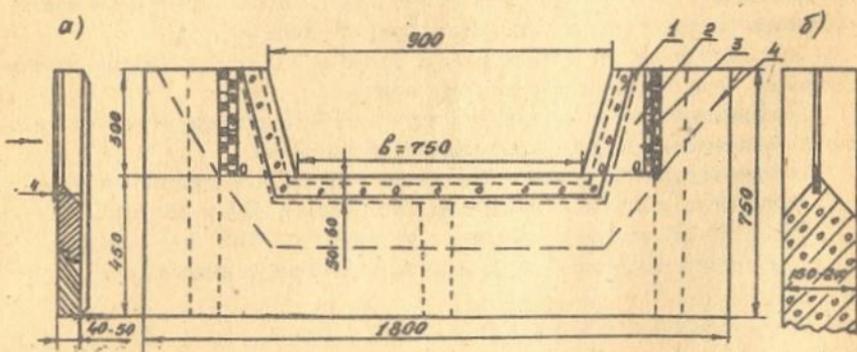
Трапецидальный водослив ВЧ-75: а - с деревянной стенкой, б - с бетонной стенкой; 1 - порог из полосового железа, 2 - стенка, 3 - рейка, 4 - сечение канала (в мм).
